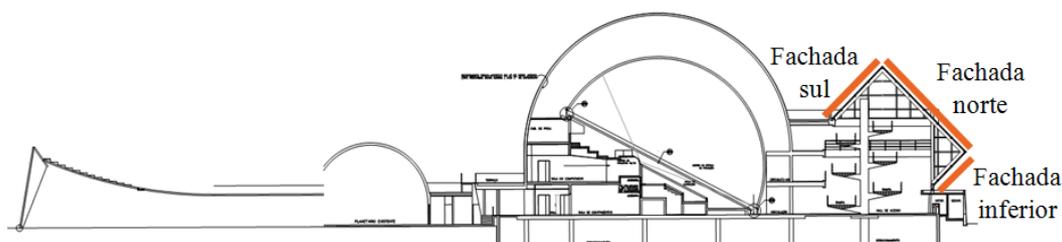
Corte do planetário e localização das fachadas norte, sul e inferior do domus.
